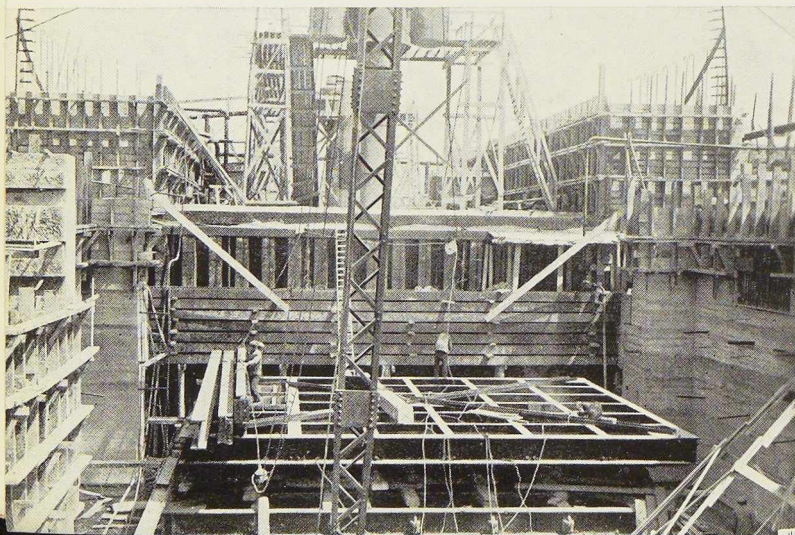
Photo prise en cours du montage d'un vantail au fond de la fouille.
